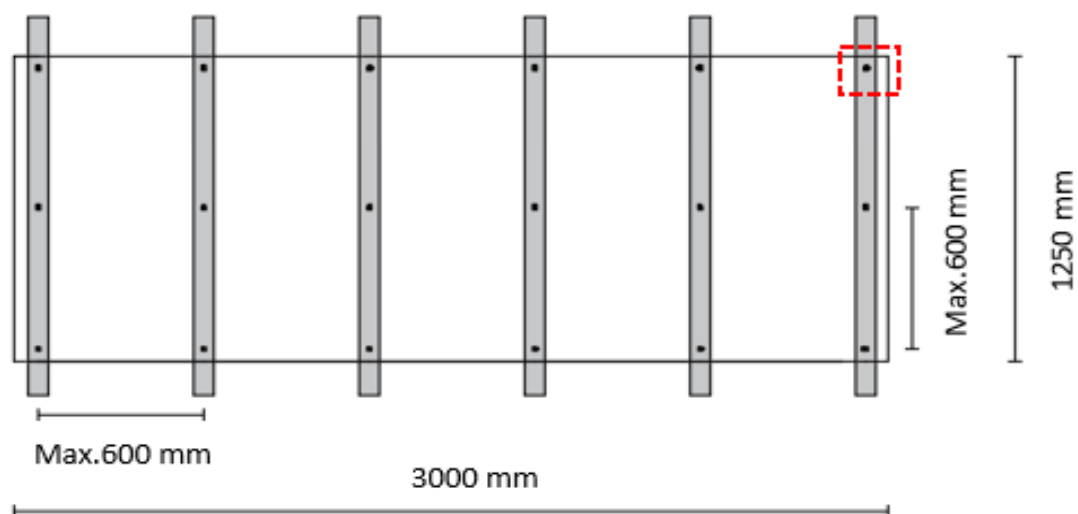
Posição de instalação do painel na aplicação em tetos falsos
